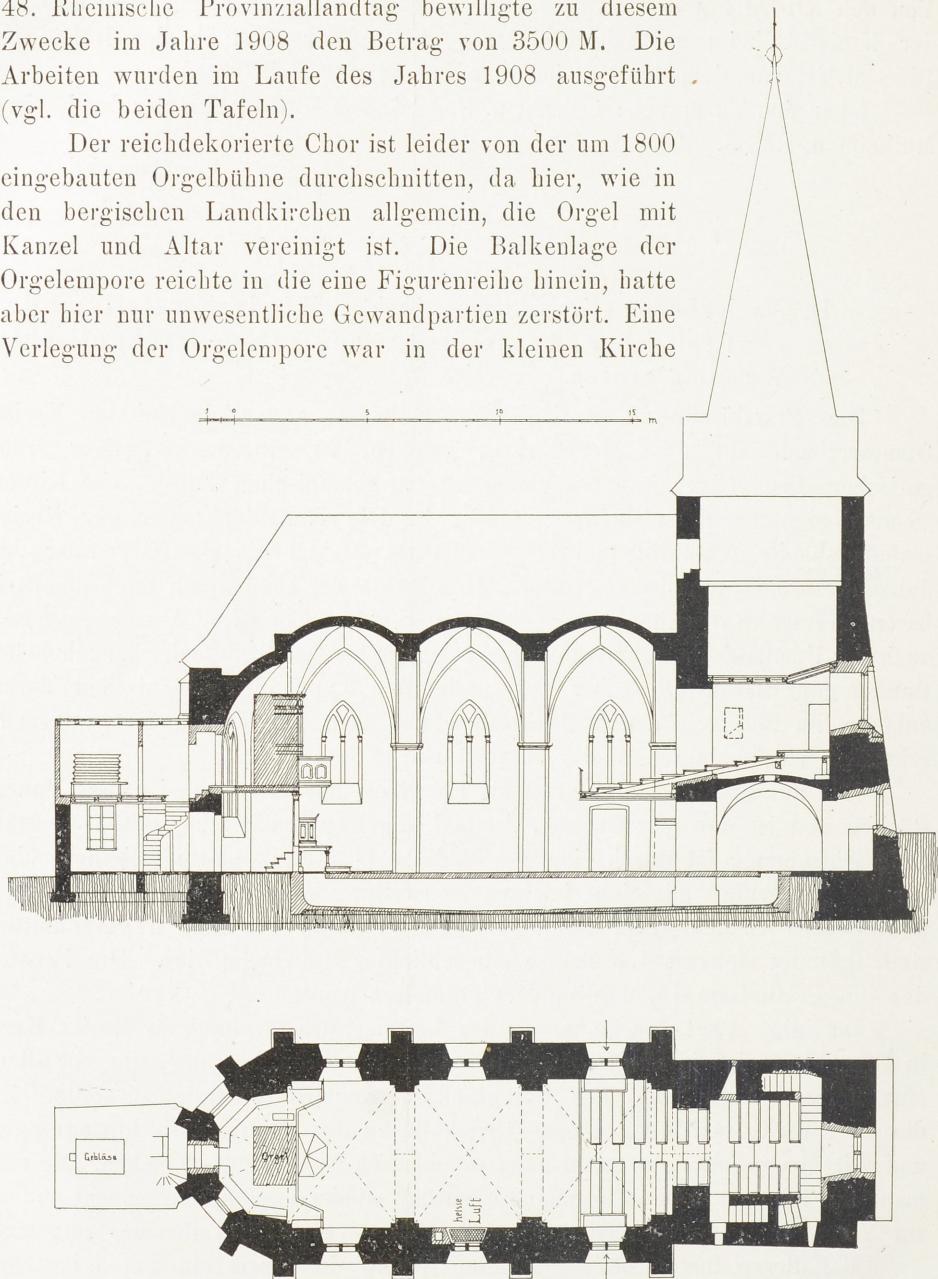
Marienhagen. Grundriss und Längenschnitt der evang. Kirche nach dem Umbau.
